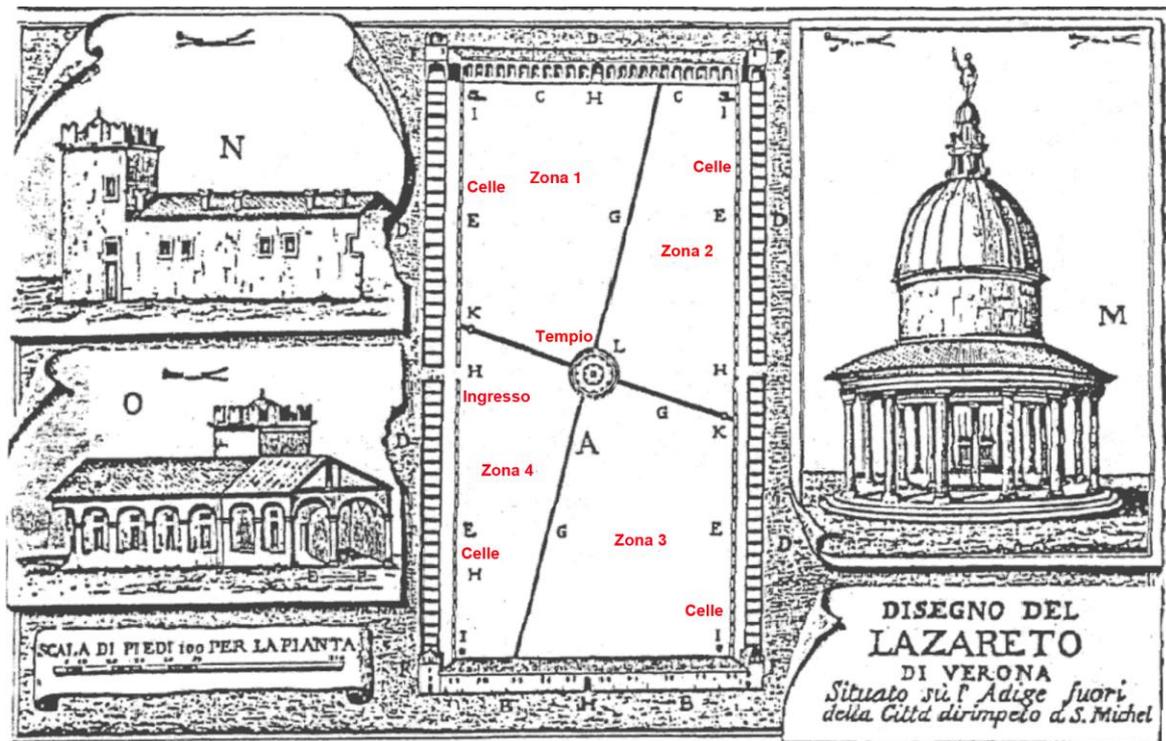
Il Lazaretto - stralcio delle strutture in elevazione, planimetria generale e alzato del tempietto – XVIII secolo
